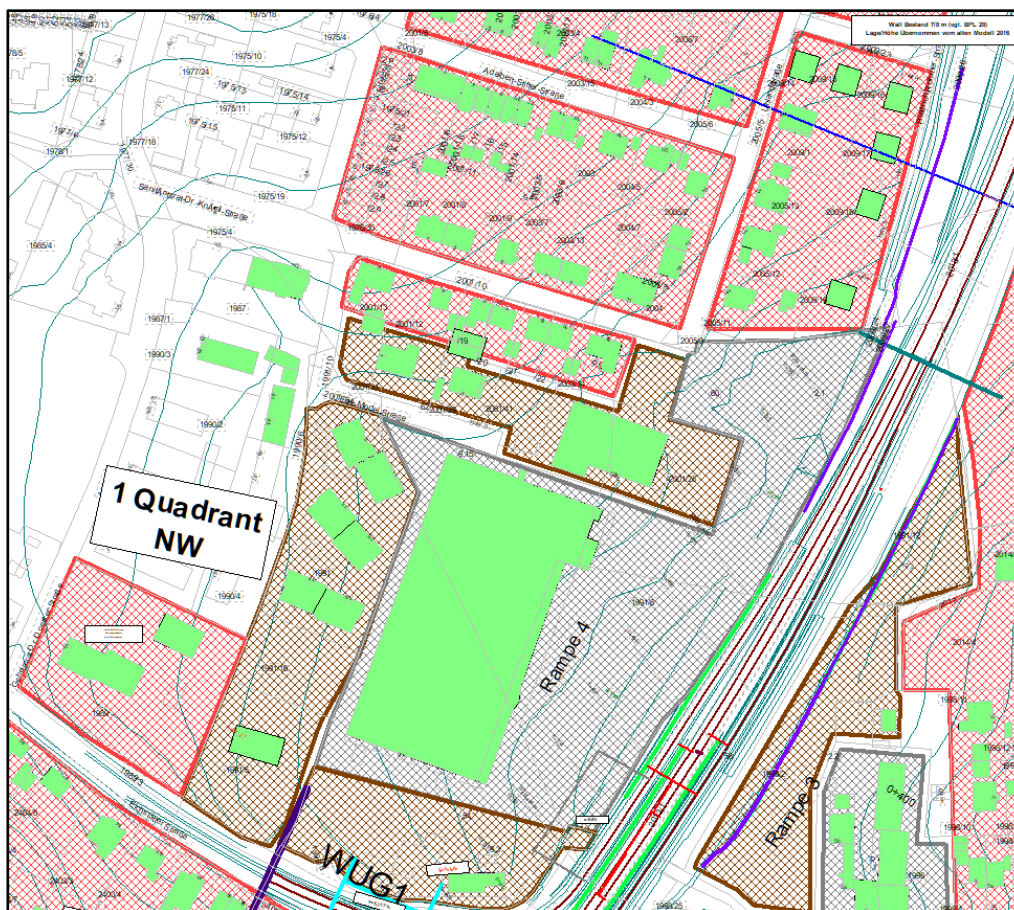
Lageplanskizze 1. Quadrant (NW)
